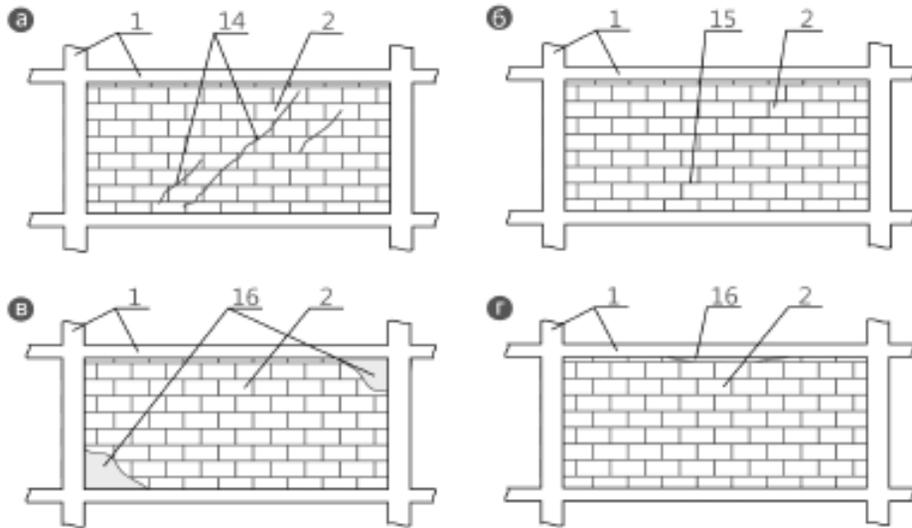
Характер повреждения кладки наружных стен на глухом участке при сдвиговых деформациях колонн и перекрытий
